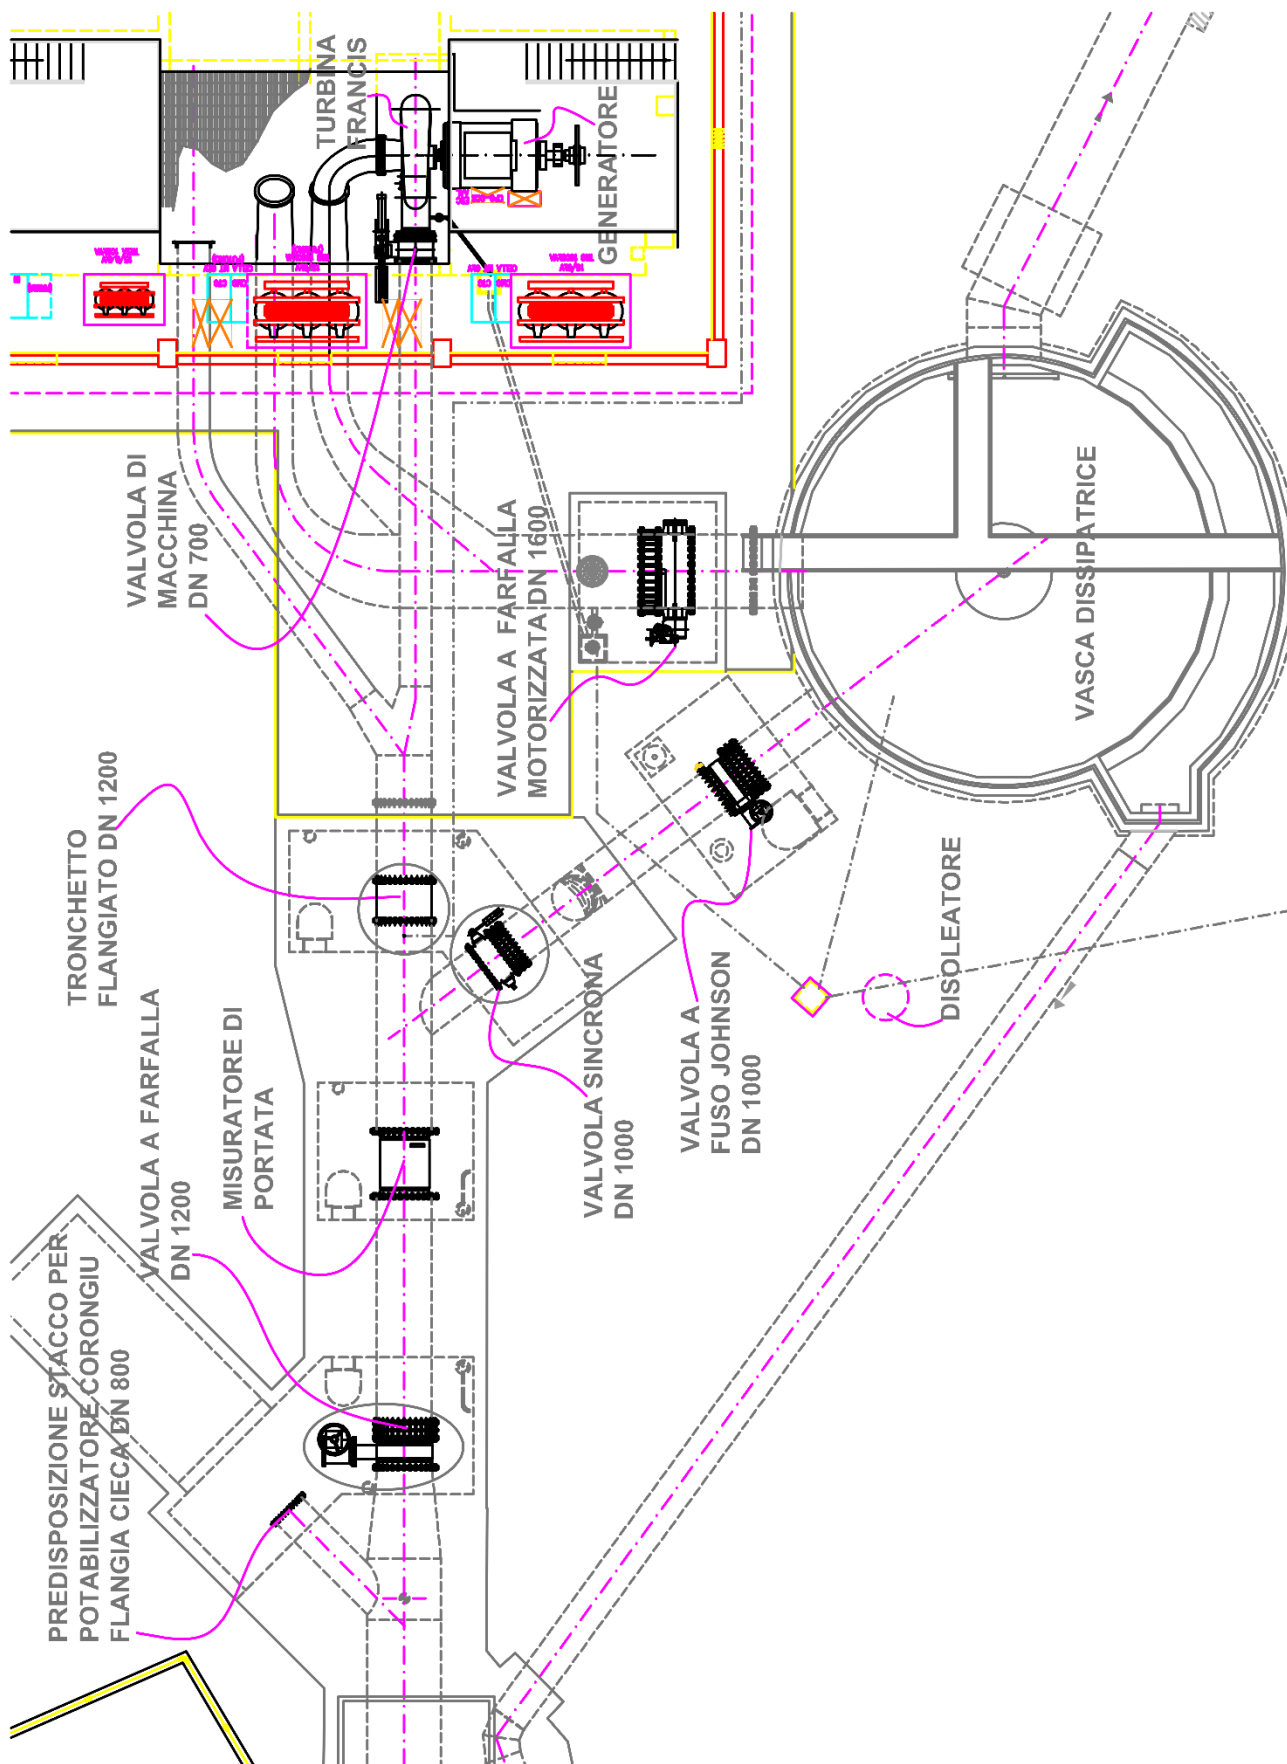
Stralcio planimetria opere di arrivo centrale idroelettrica di Simbirizzi.
